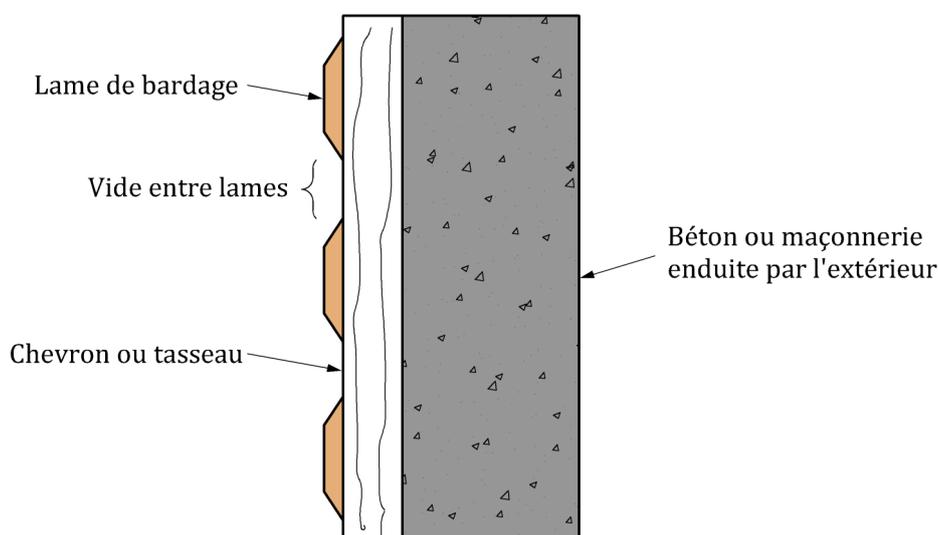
Bardage horizontal posé sur béton ou maçonnerie enduite par l'extérieur
